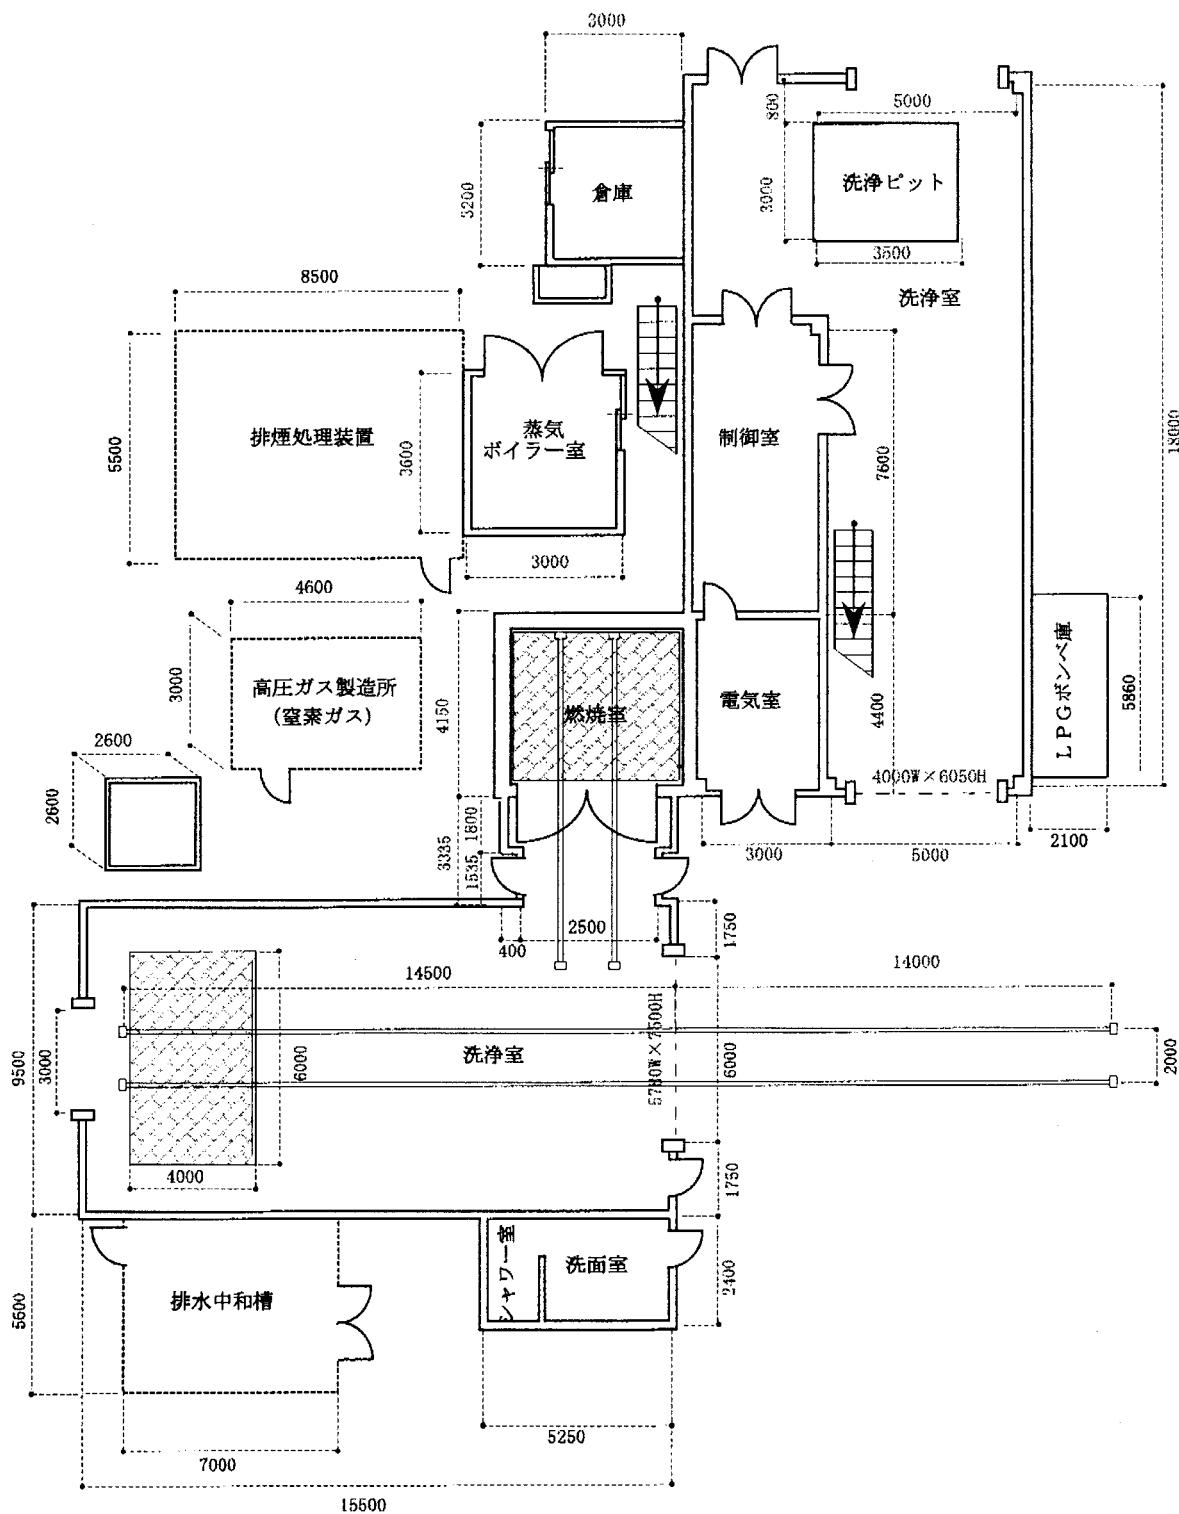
(1/2) ナトリウム処理室の構造図 (平面図)
